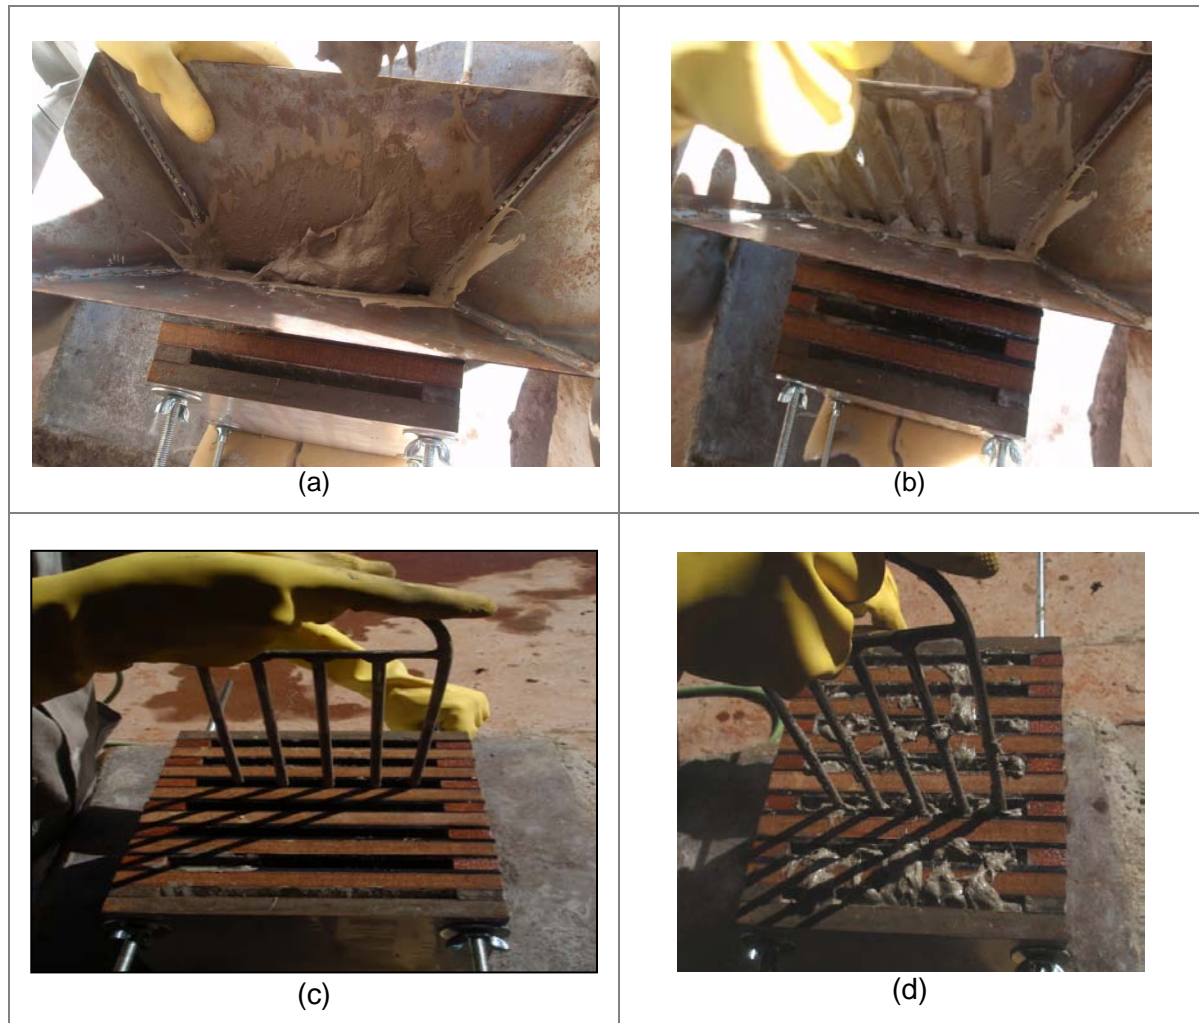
Moldagem das placas utilizando o funil e o 'pente'
